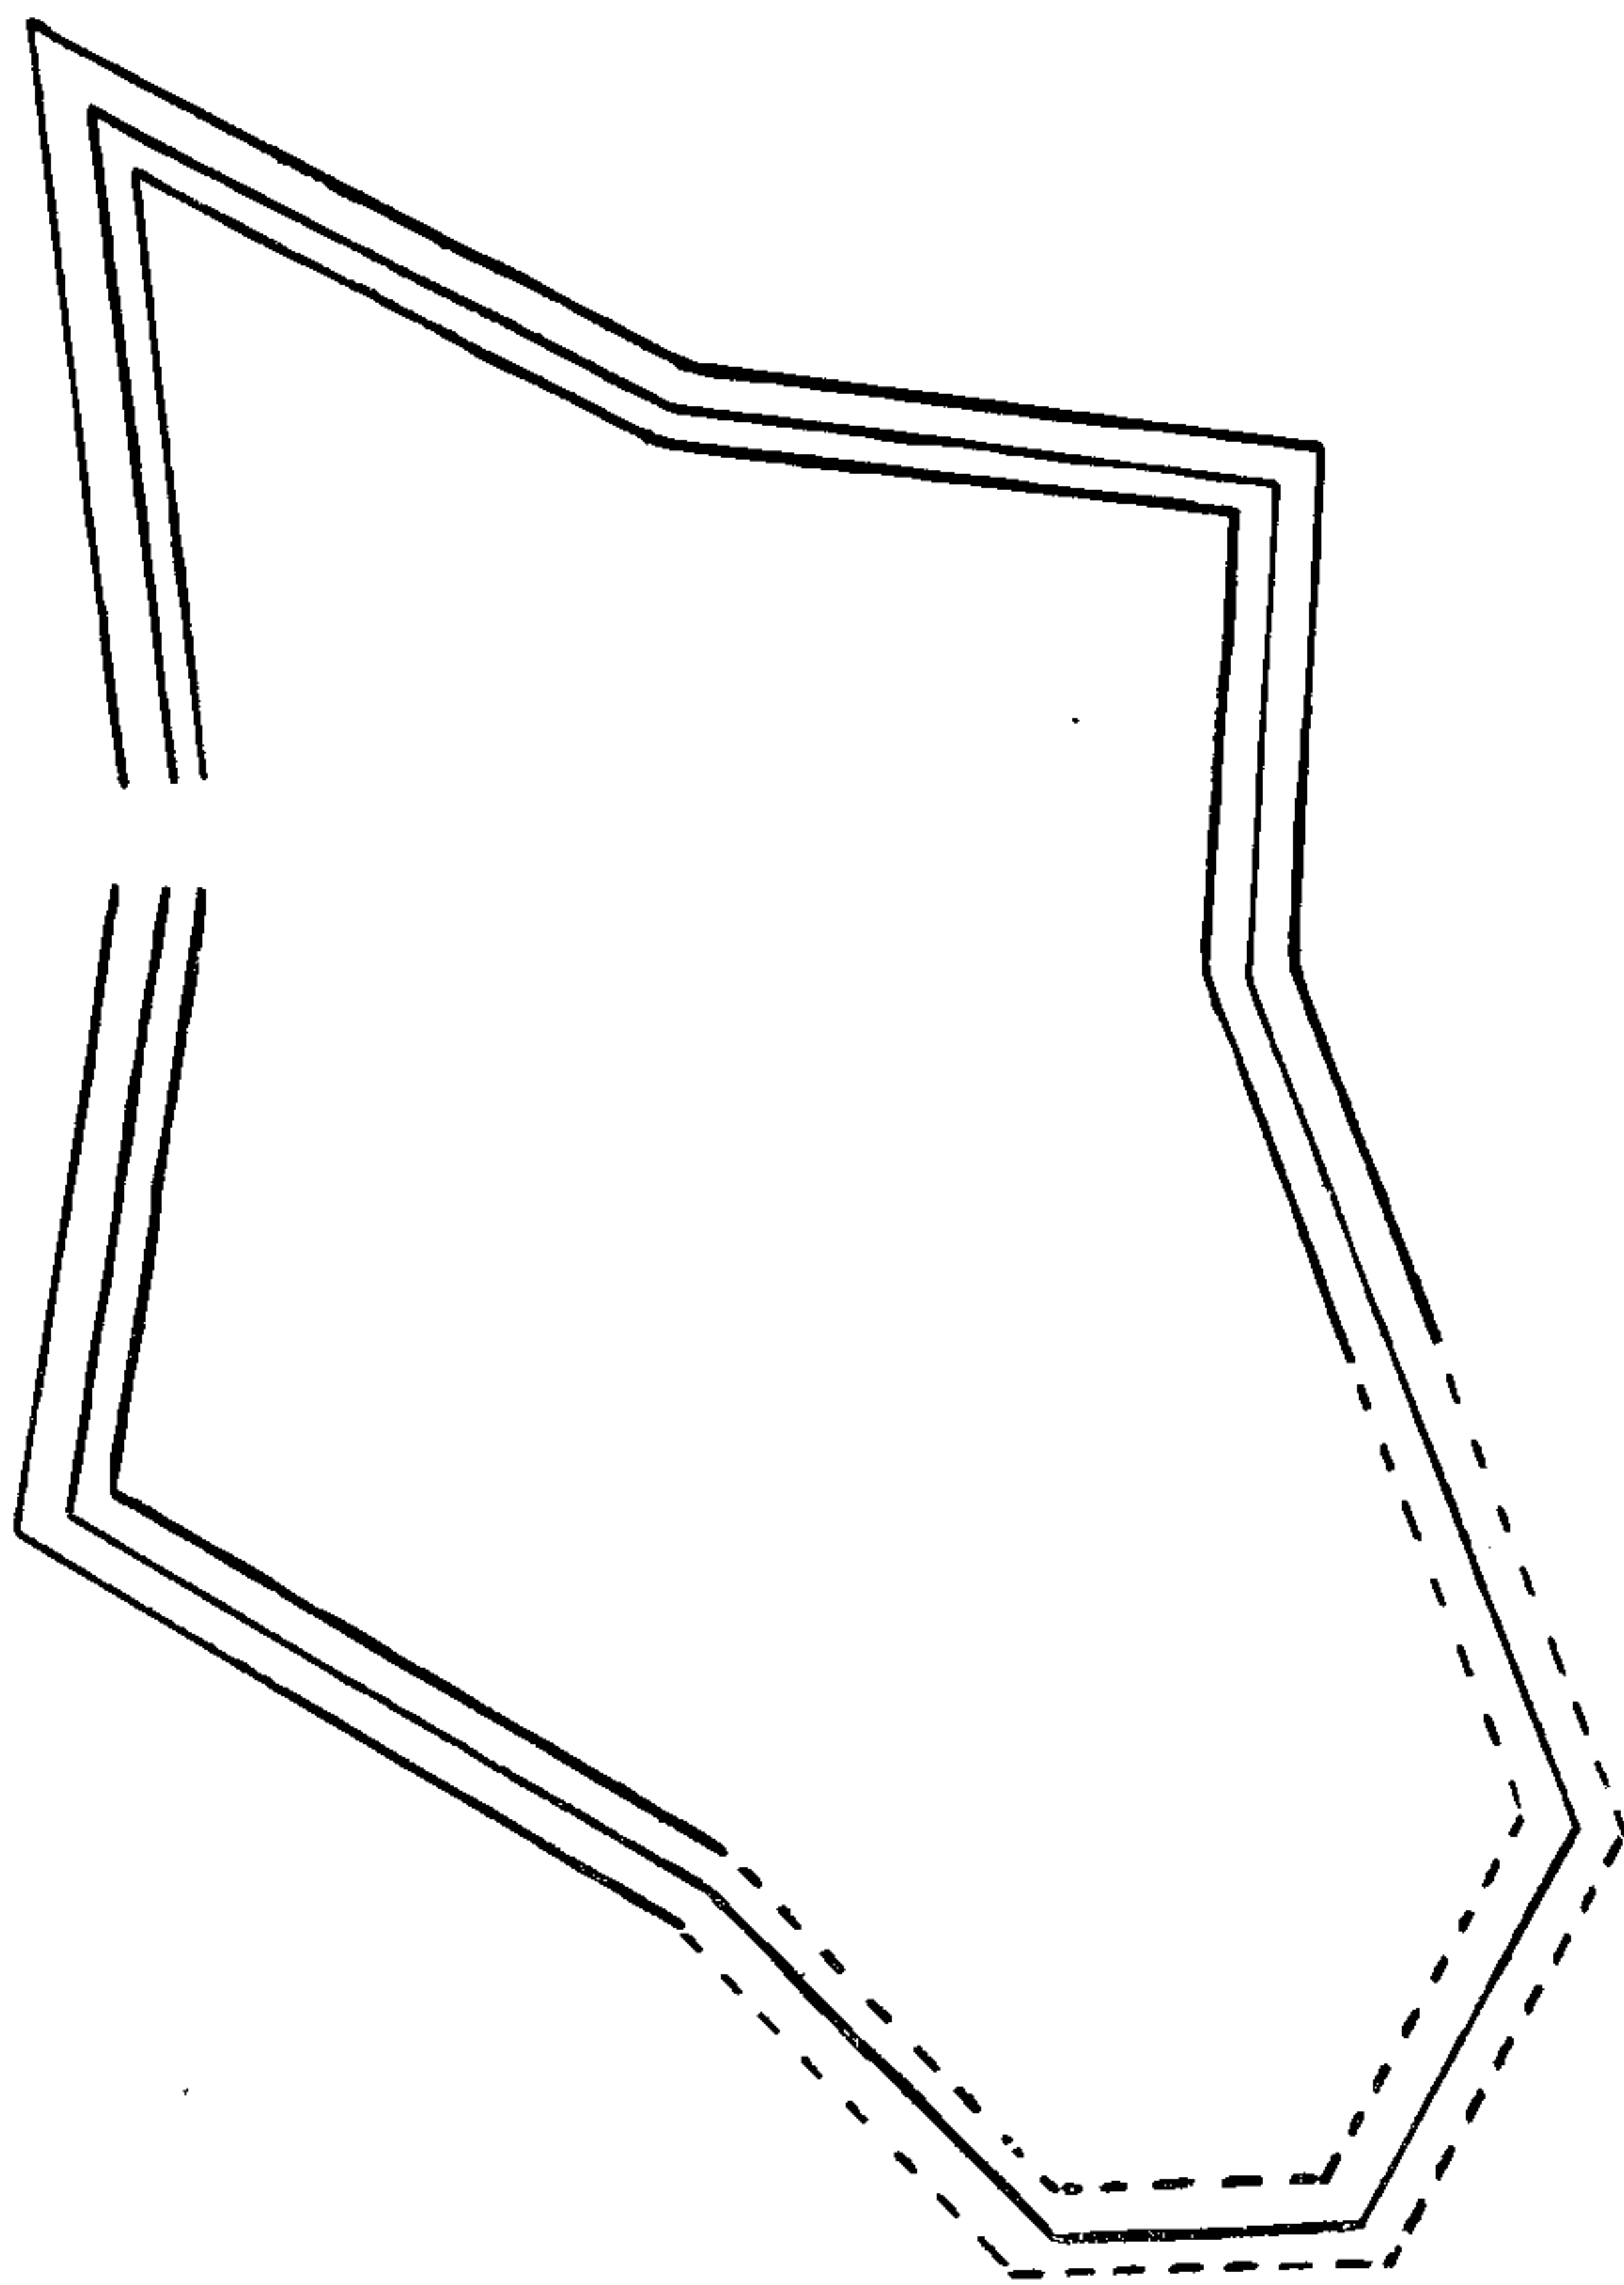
Forte de Santo Antônio da Barra. Pormenor da planta existente no Arquivo do Ministério da Guerra.
